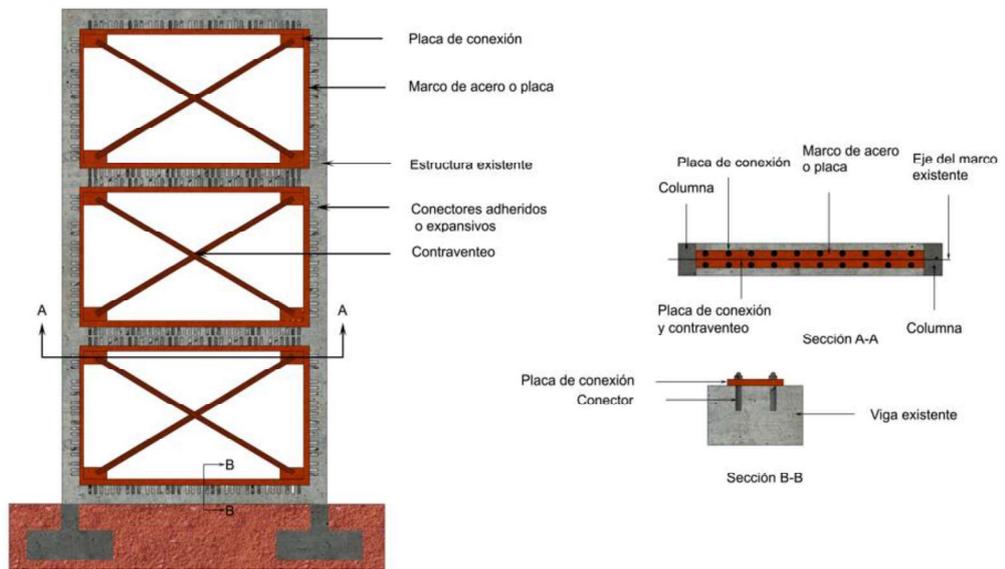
d – Contraventeo concéntrico en X conectado al marco existente por medio de un marco perimetral metálico (INIFED, 2021d)
